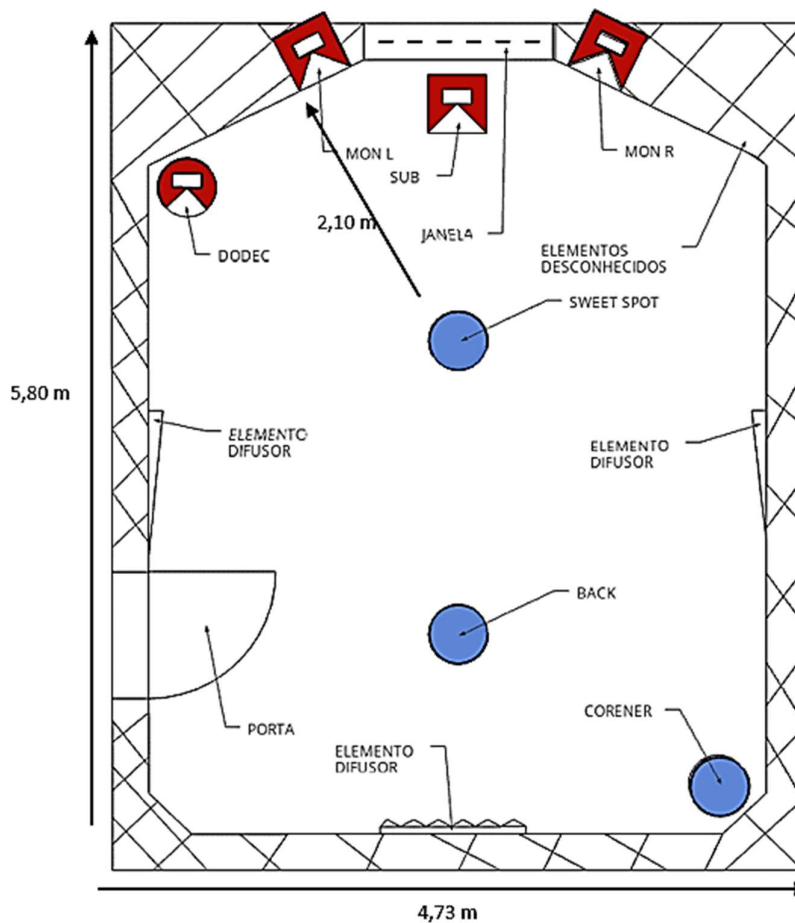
Visão em planta da sala "Estúdio Miramar"
